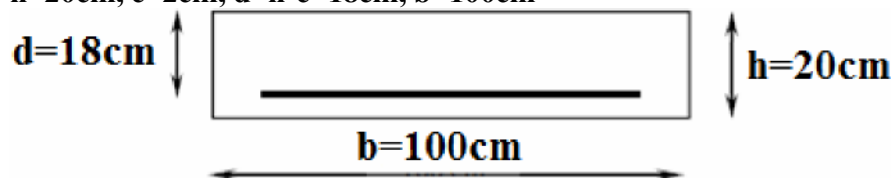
Schéma statique de ferrailage d'escalier a l'ELU
